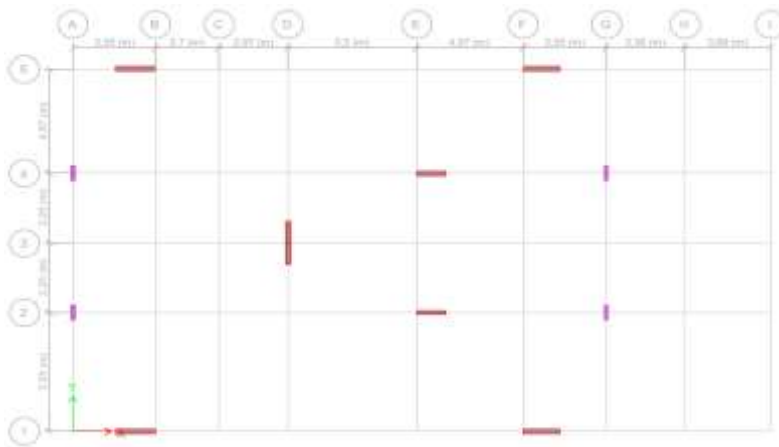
Disposition des voiles de contreventement aux niveaux (1.2.3.4.5.6.7.8)
